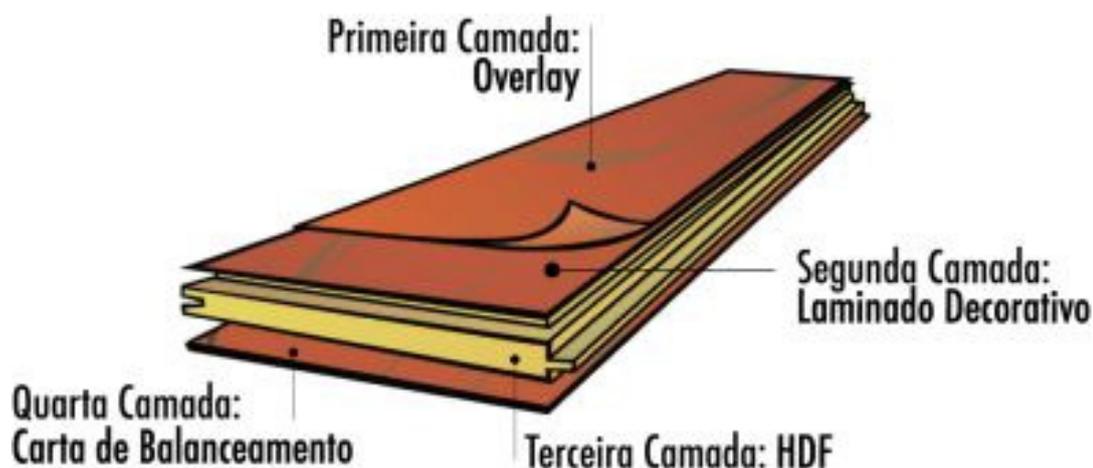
Detalhe do piso laminado de madeira. Fonte: MADFLOOR (2007).
